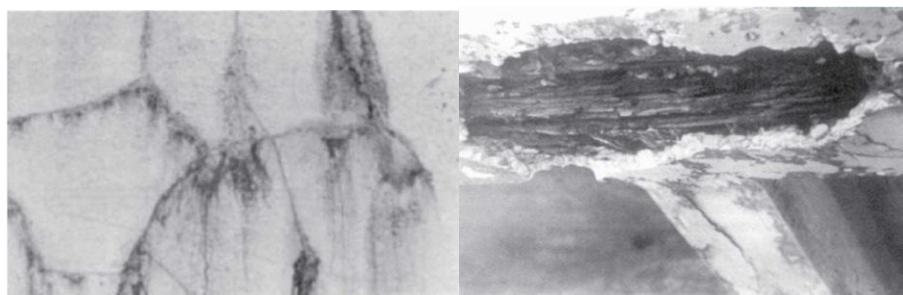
Fissuração por retração e fissuração com deslocamento causada por corrosão das armaduras - Fonte: SOUZA e RIPPER (2009).
